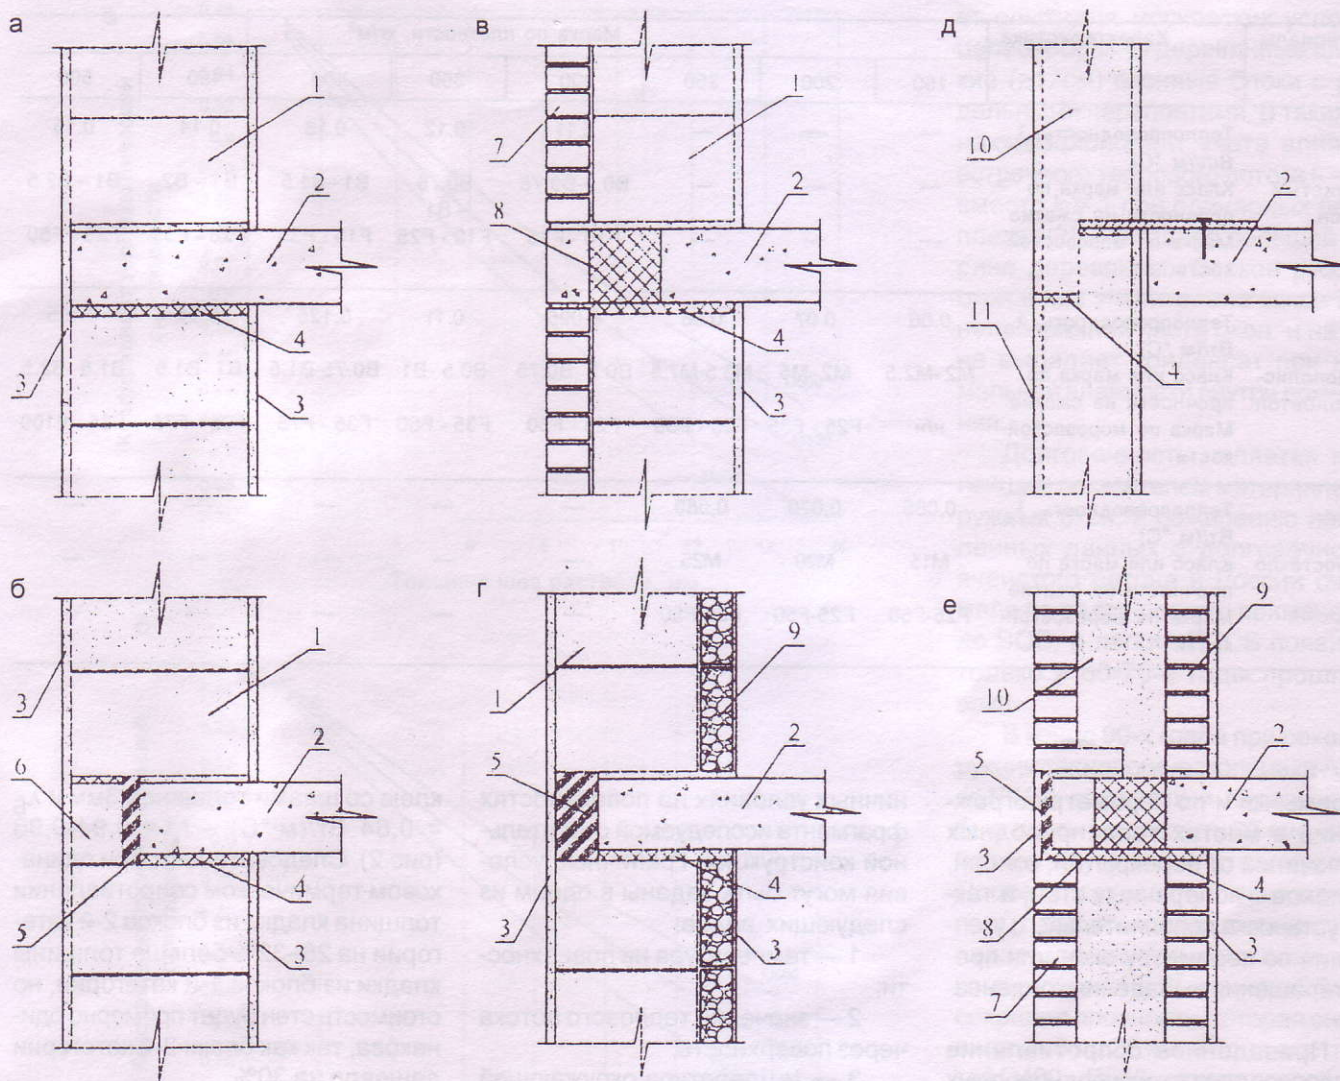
Несущие стеновые ограждения с теплоизоляцией перекрытий
